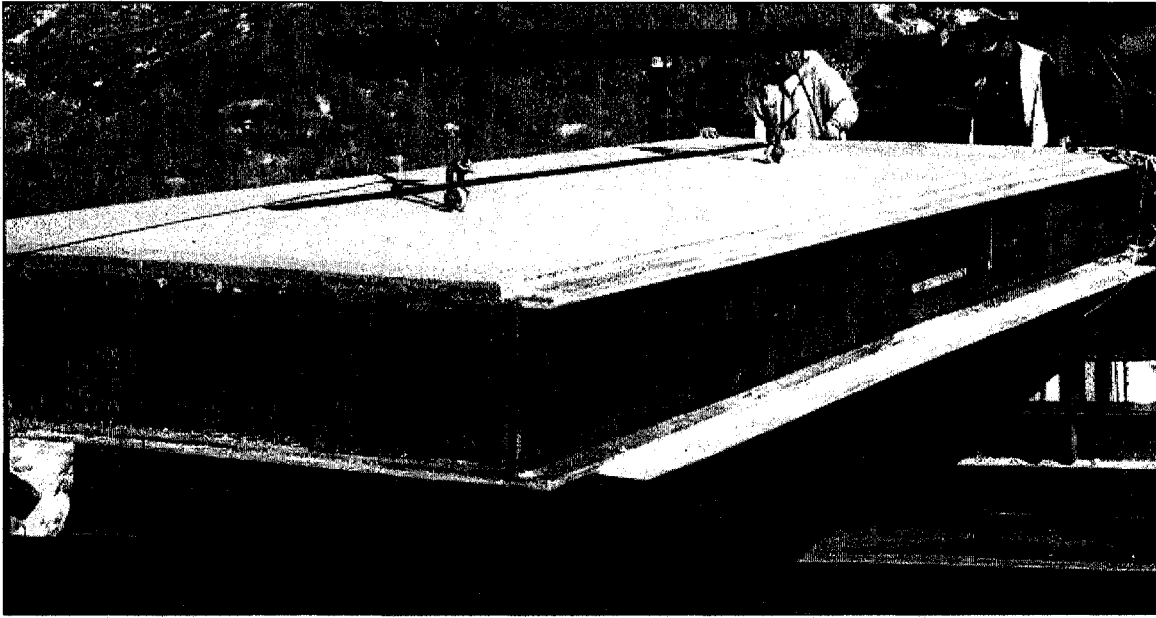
Installation d'une dalle produite par *Kansas Structural Composites Inc.
